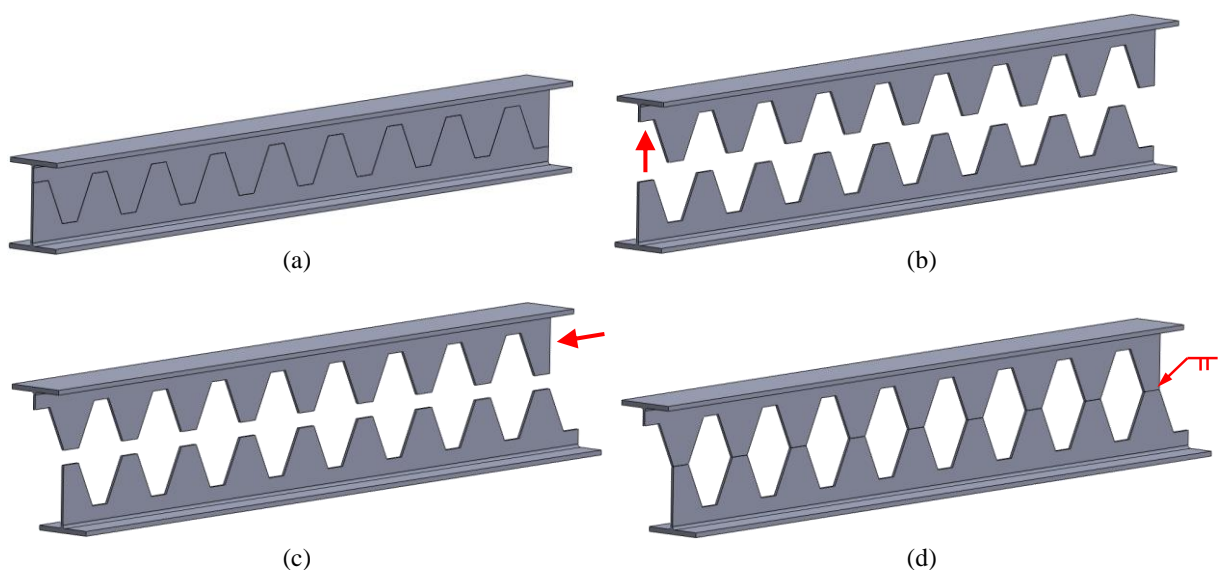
Esquema do corte e montagem de vigas alveolares casteladas
